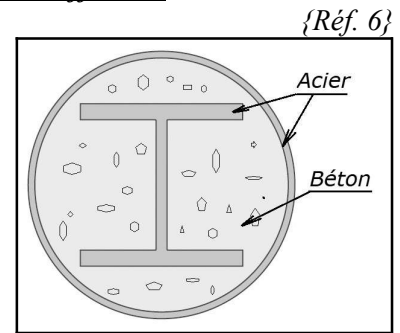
Colonne mixte : poutrelle insérée dans un tube rempli de béton.
